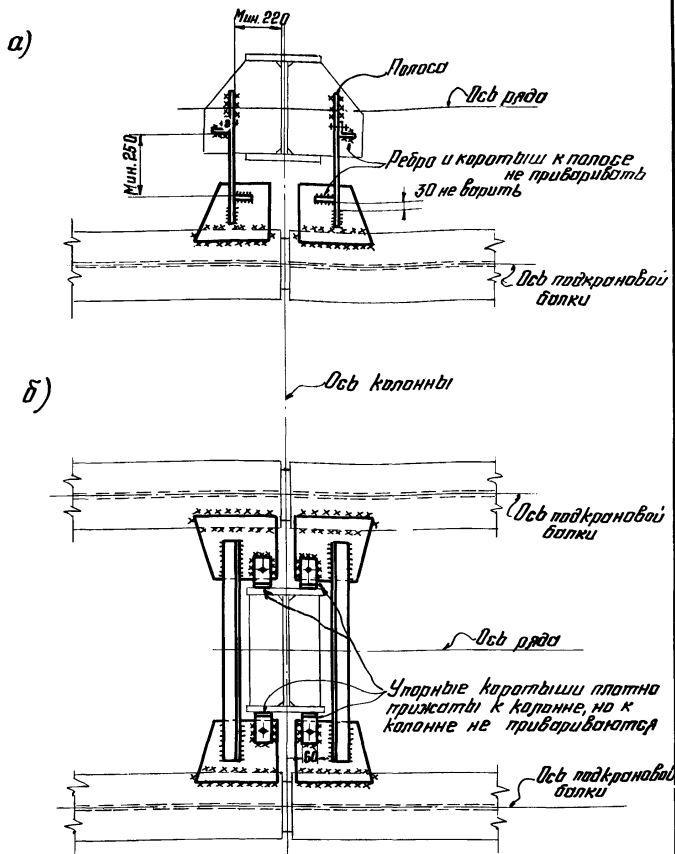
Крепление верхнего пояса разрезных подкрановых балок к стальным колоннам при отсутствии тармазного устройства:
